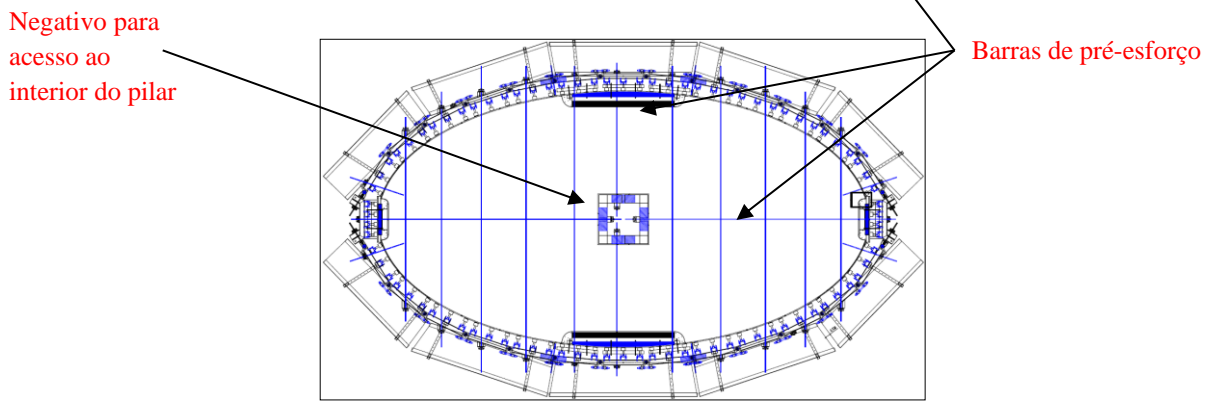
ELEVAÇÕES PARA EXECUÇÃO DO PILAR
